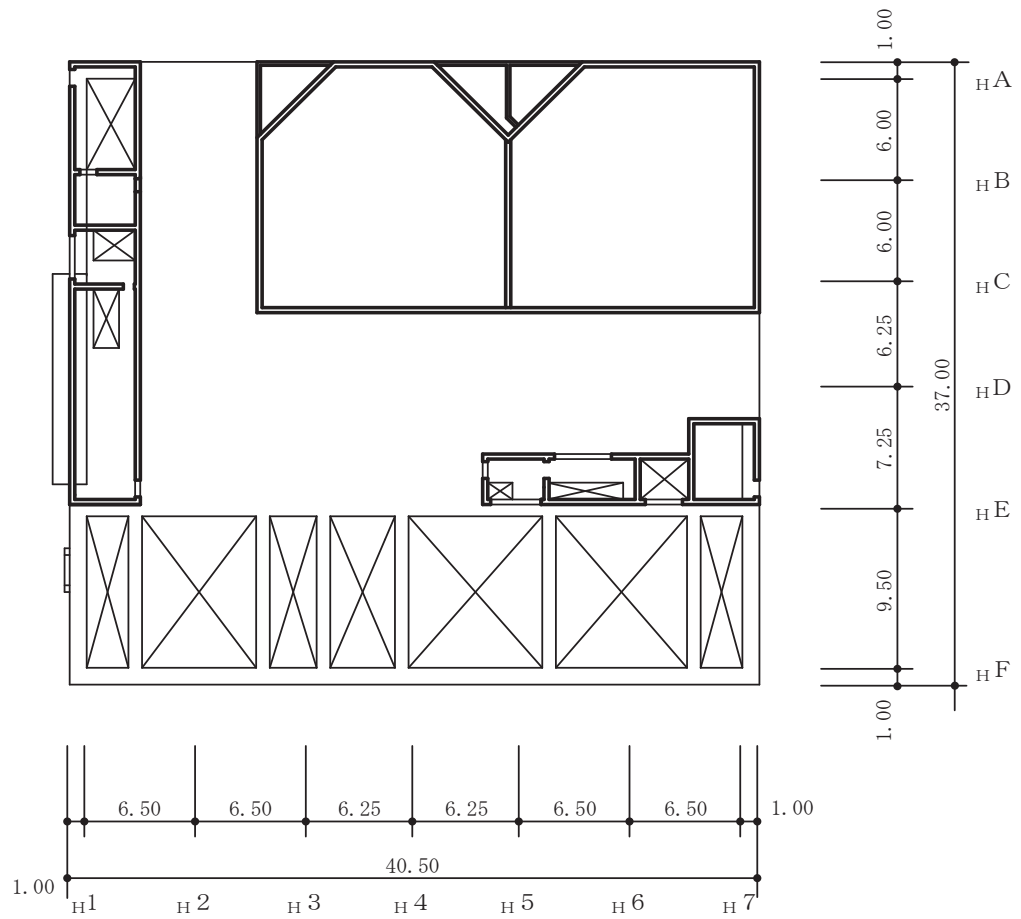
(2) 第3号機海水熱交換器建屋の概略平面図 (O.P. -1.1m)
